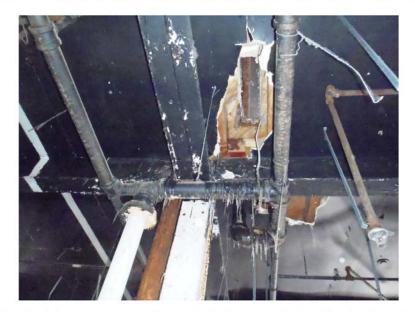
Présence de glace sur la charpente d'acier du plancher de l'étage dû au bris d'un conduit
